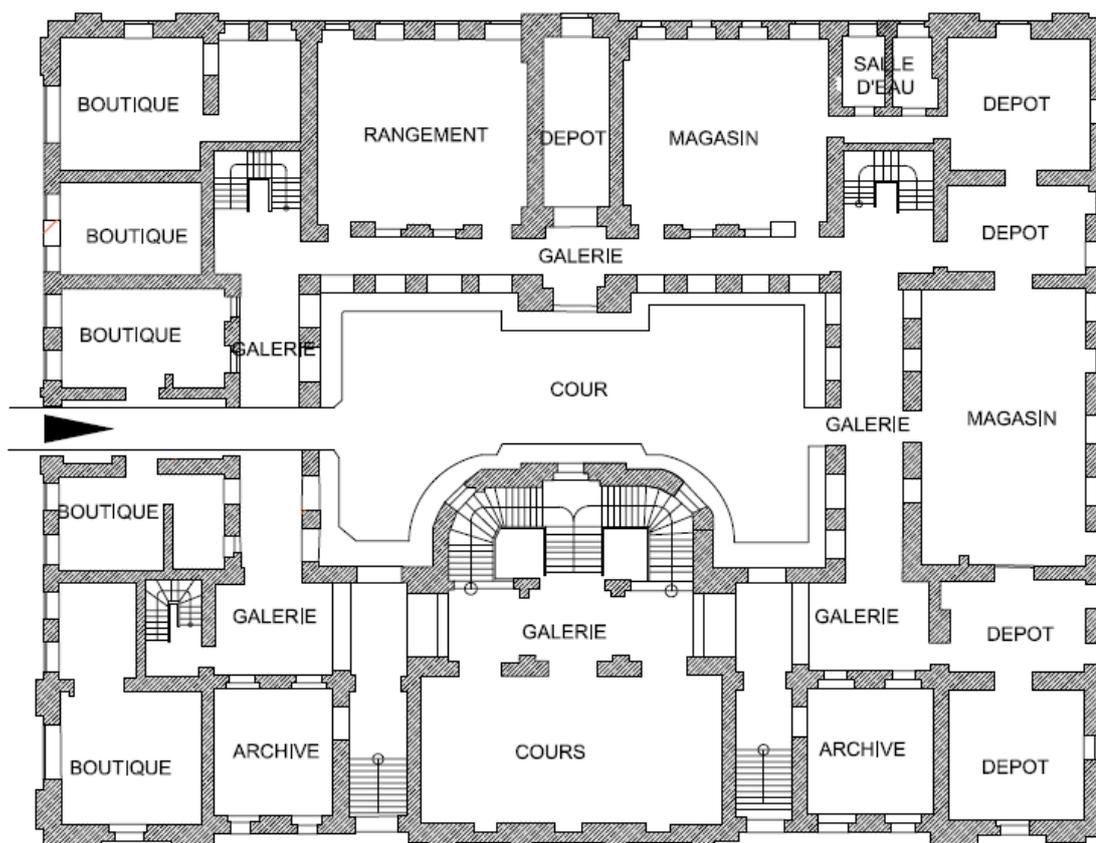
Plan de l'entresol de l'hôtel de ville d'Oran.
